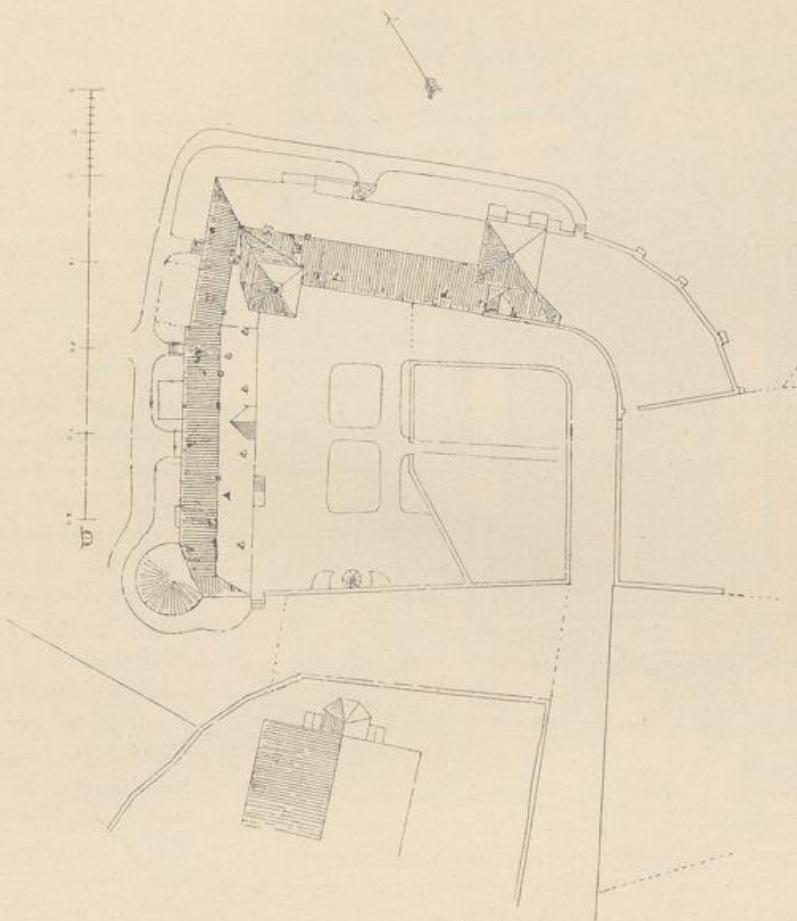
Hückeswagen. Grundriss des Schlosses.
